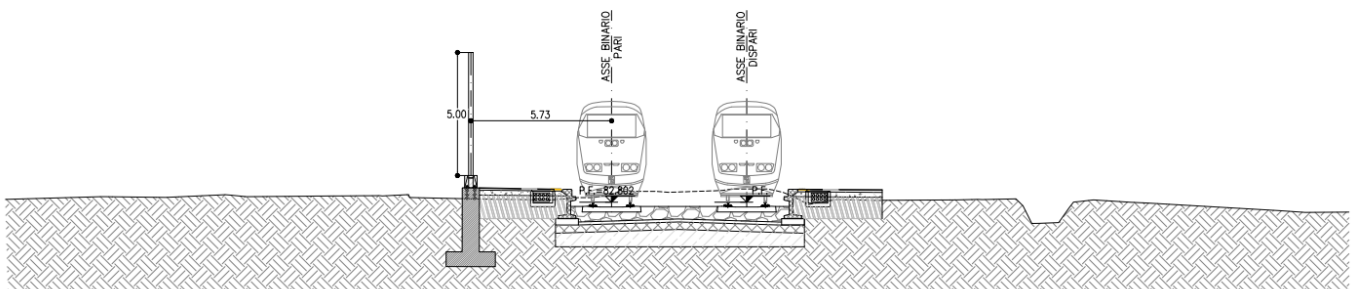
Sezione tipo tipologico BA31 “Trasparente Su Muro FV01”
